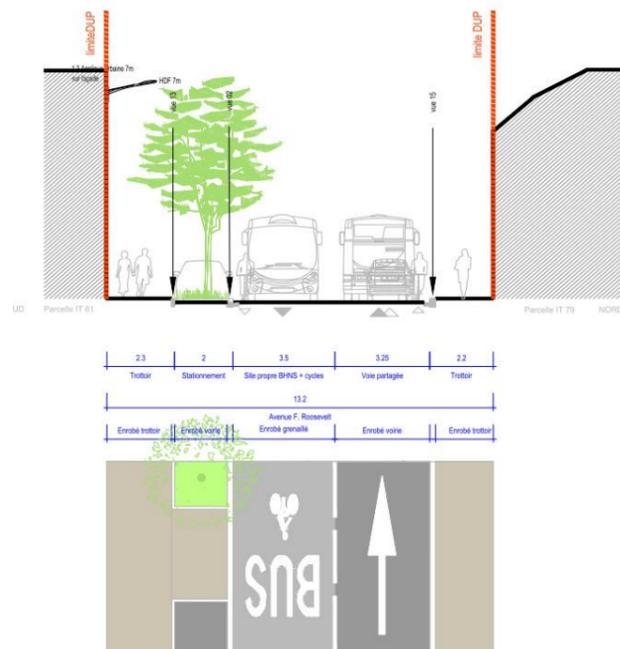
Coupe d'insertion sur la rue Roosevelt (AVP)
